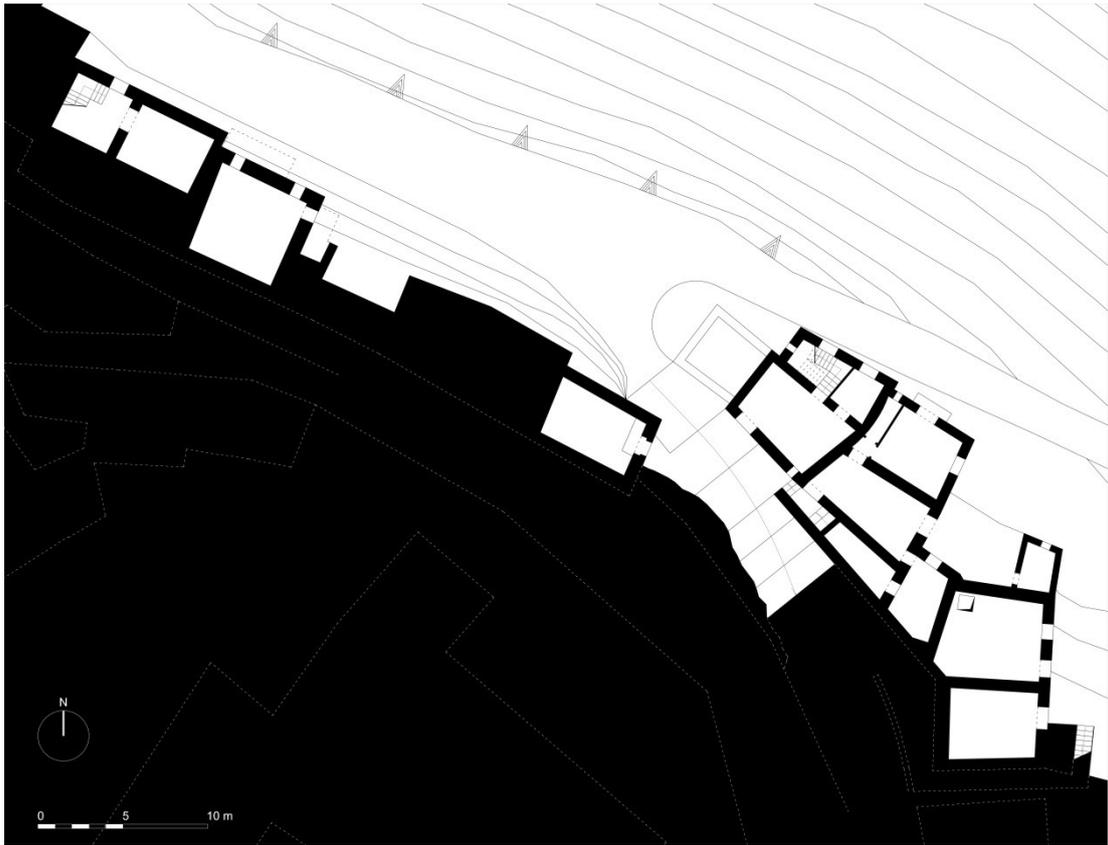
Comparto n°4 / Planimetria del secondo livello sotto strada
